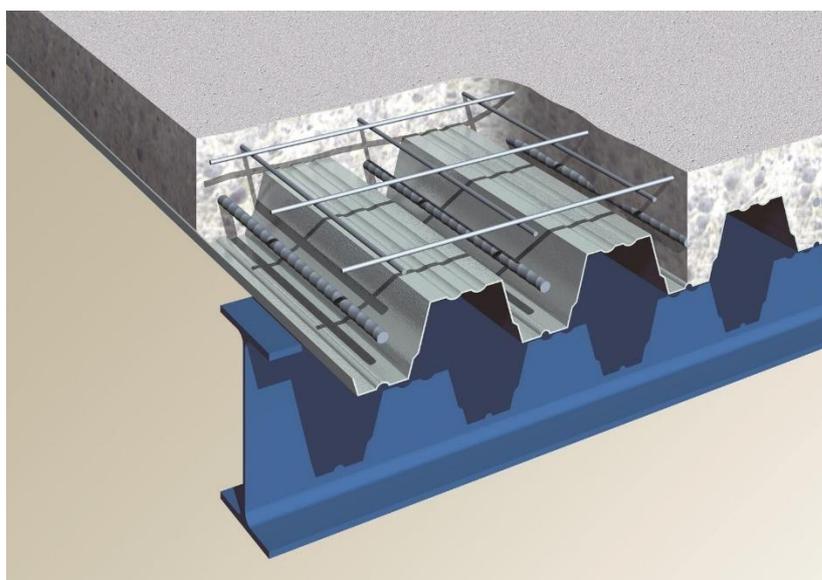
Esquema da tecnologia de uma laje colaborante [35]
